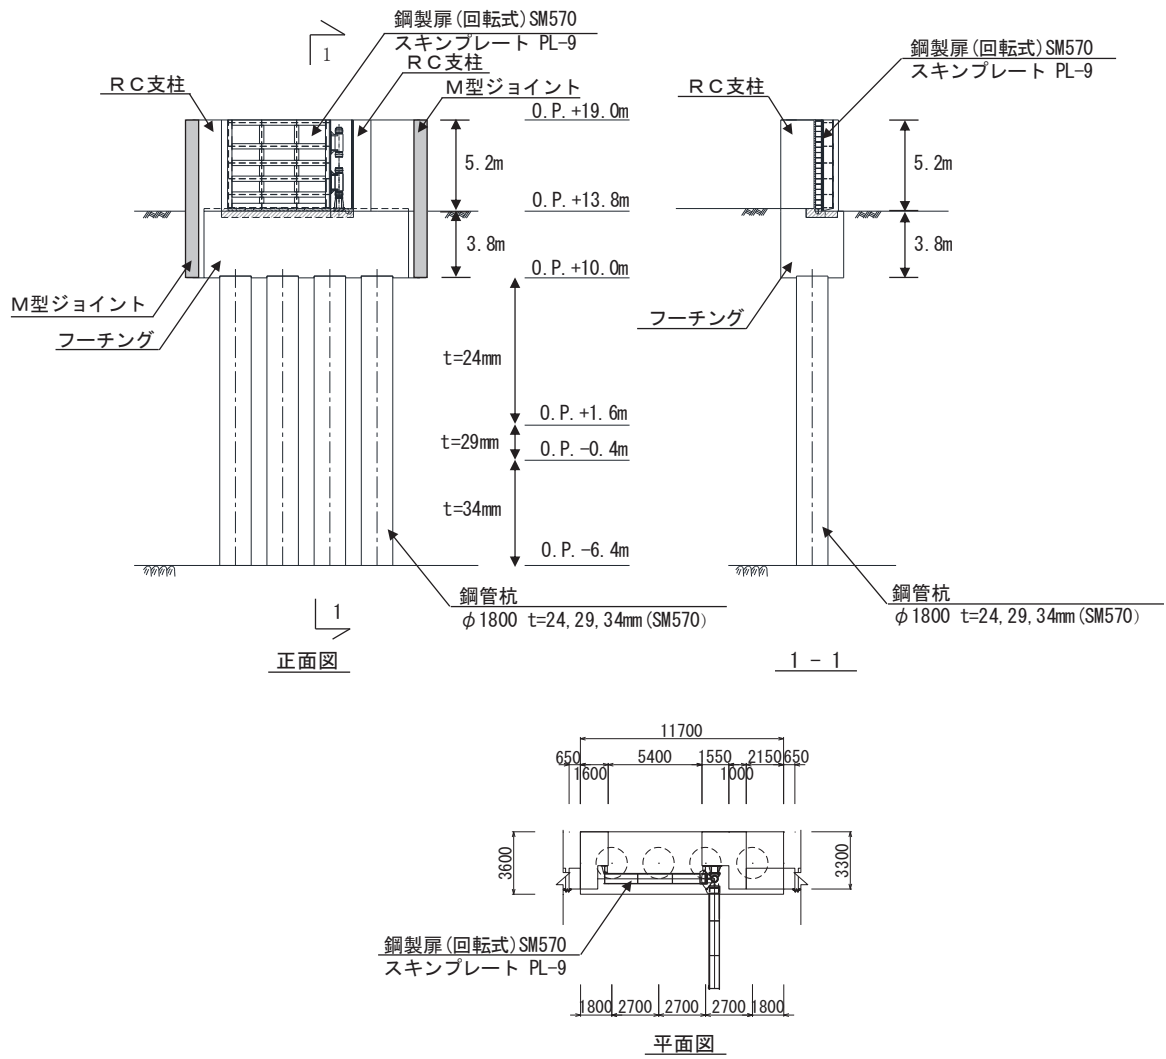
鋼製扉 4 の構造図 (正面図及び断面図, 平面図)
